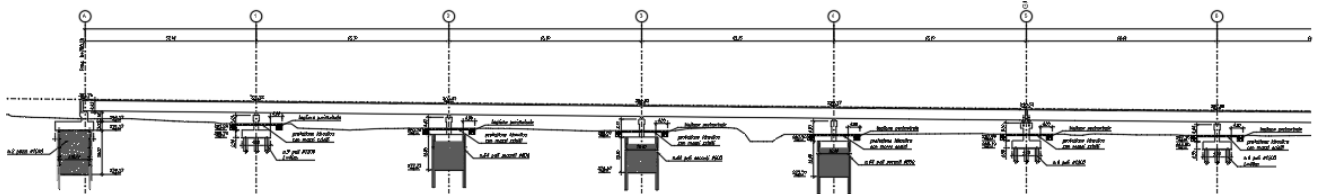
Sezione longitudinale carreggiata direzione Grosseto
